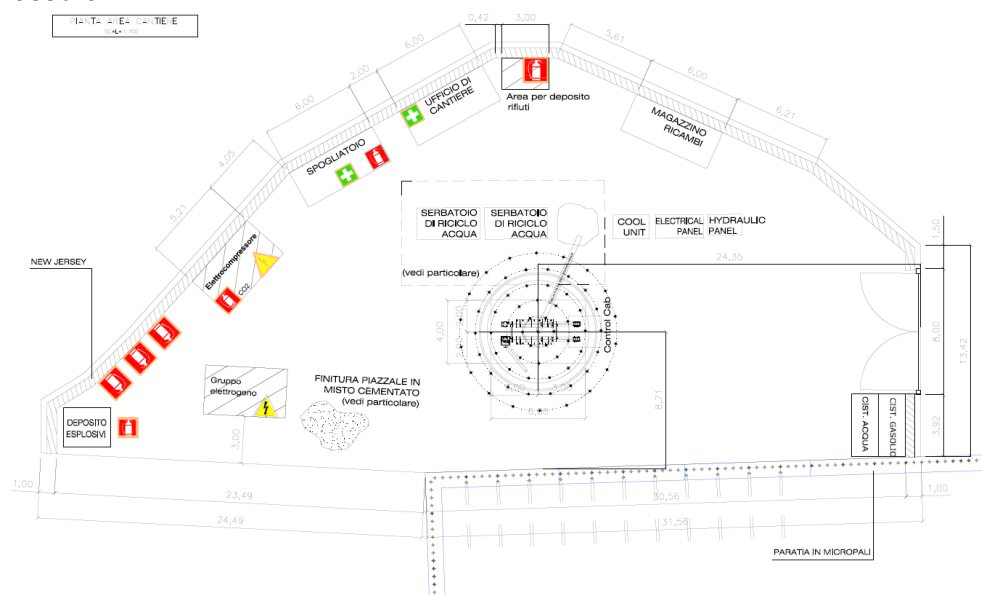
Cantiere pozzo: fase 1 – scavo con rise boring
